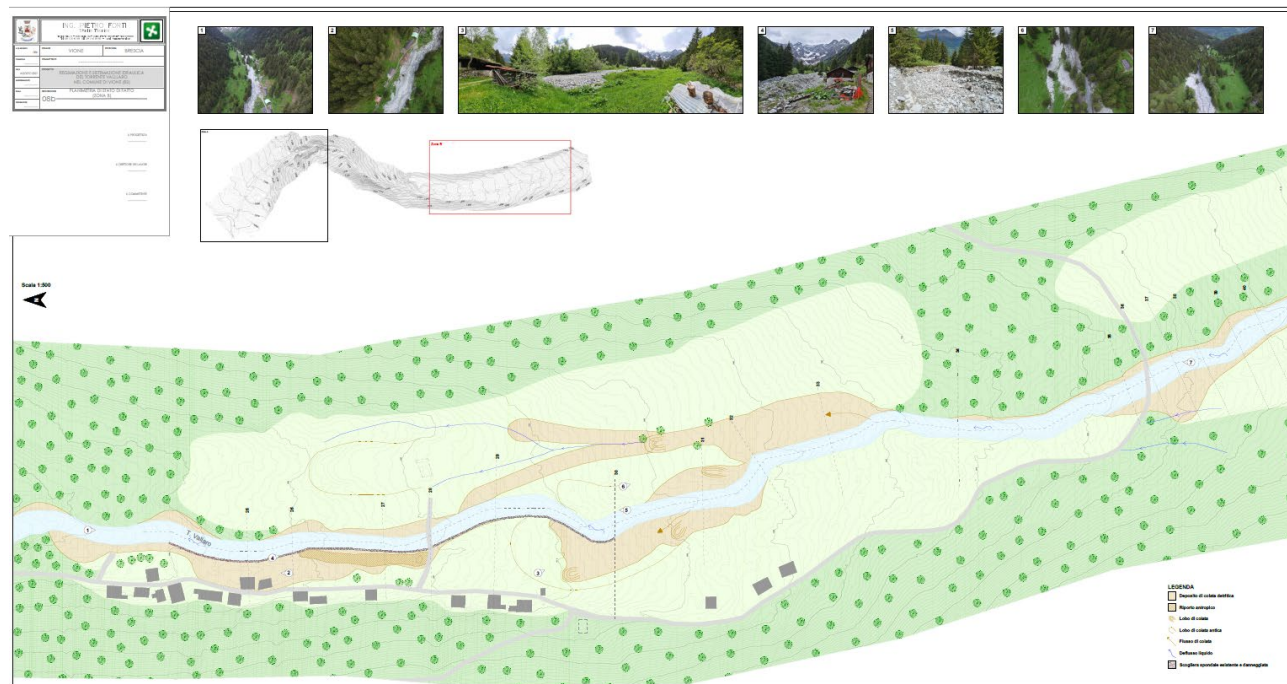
Estratto tavola 8b - Planimetria stato di fatto
